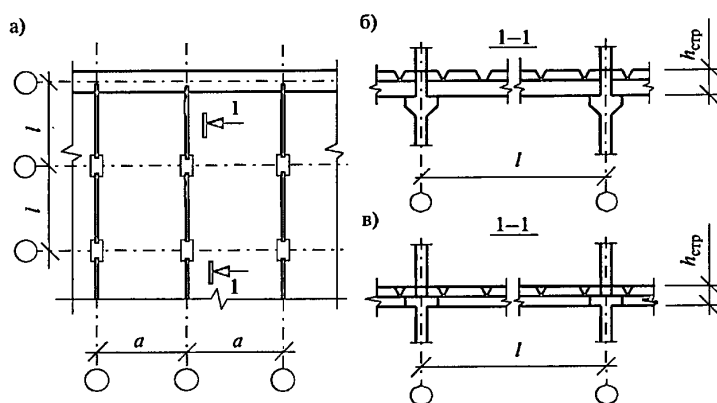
Участок плана и разрезы сборных железобетонных перекрытий: а) участок плана железобетонного перекрытия; б) разрез перекрытия с плитами, опирающимися на верх ригелей; в) разрез перекрытия с плитами, опирающимися на нижние полки ригелей
